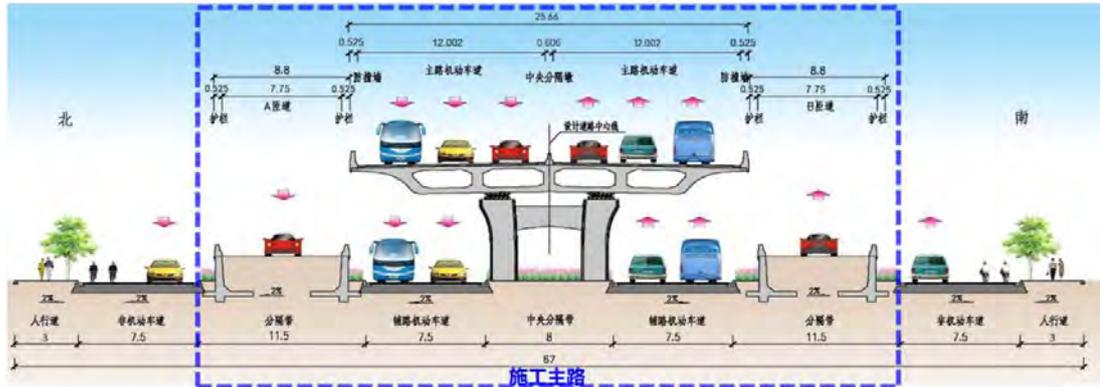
烟花三月路~曙光路第二阶段施工断面示意图
